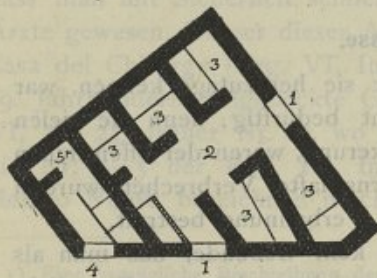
Grundriss des Lupanare nuovo.
